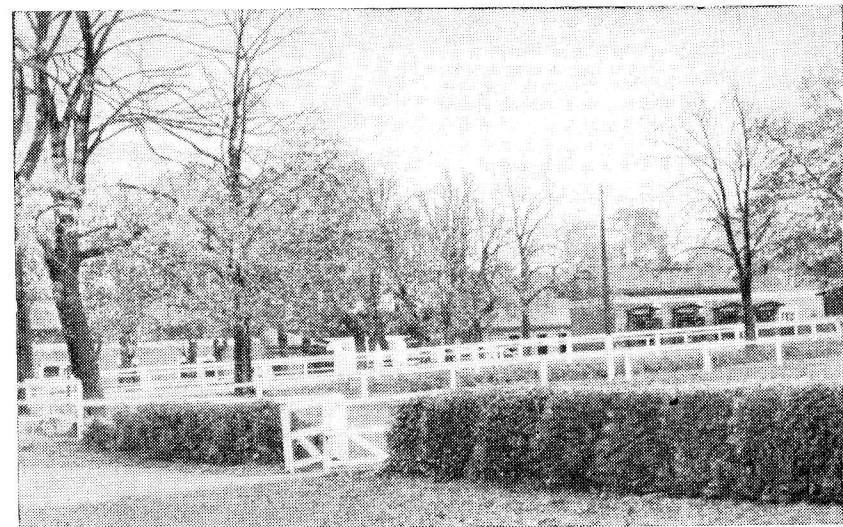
Изгородь из железобетонных столбов и деревянных жердей в один ряд. На переднем плане живая изгородь из кустарника (ЧССР).
